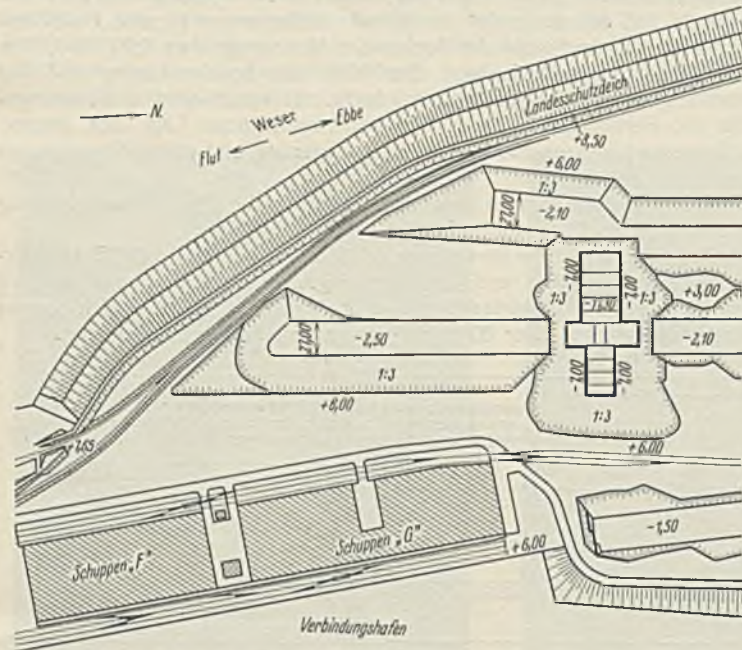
Baugrube des Außenhauptes mit anliegenden Kunstbauwerken.
